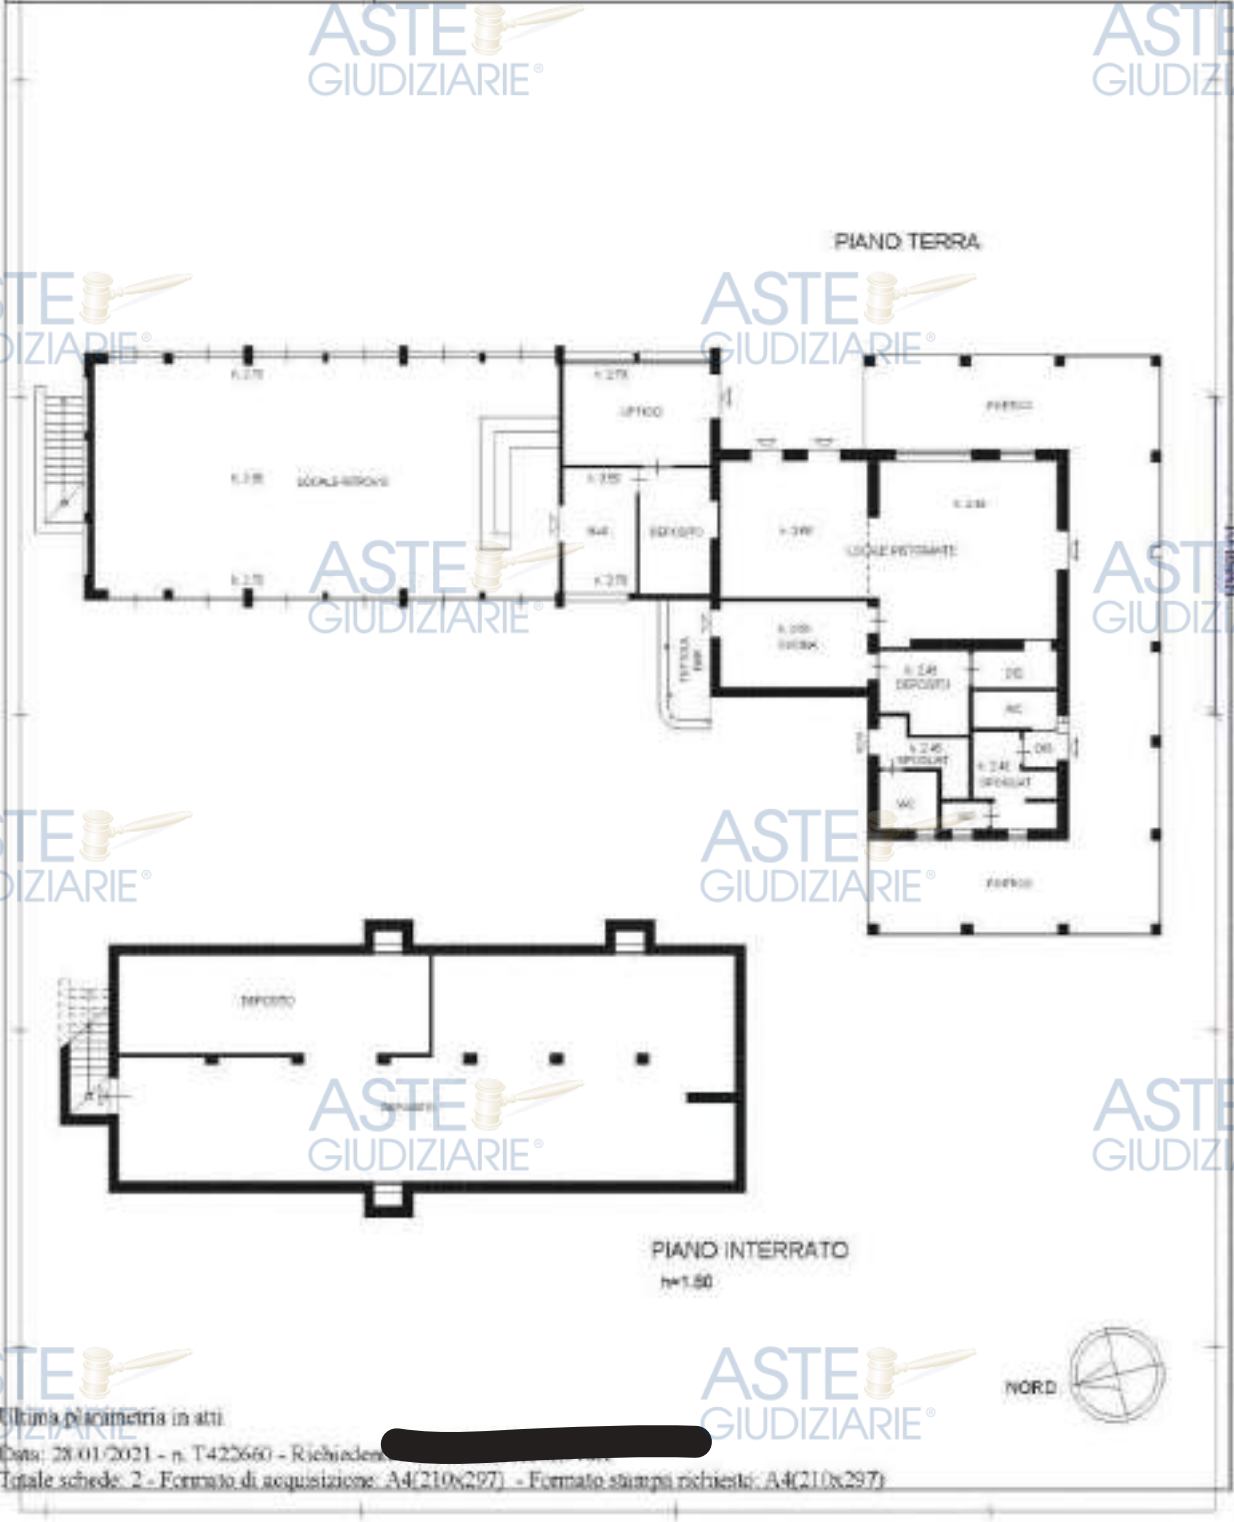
Visura planimetrica catastale aggiornata Fg. 7 Part. 449 Sub 1 (parte 1)
